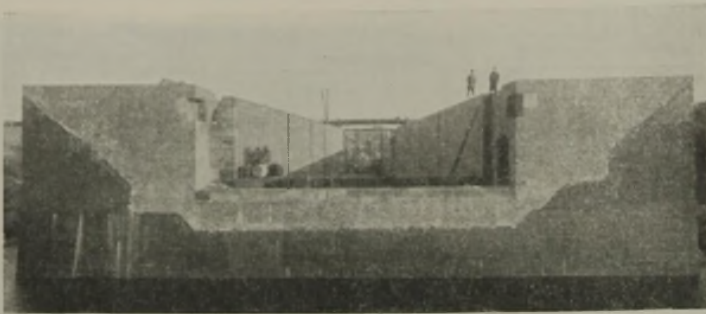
Blick gegen das Oberhaupt der Schleuse, oben Klinkerverblendung, unten Betonmauerwerk mit Inertol zweimal gestrichen.
